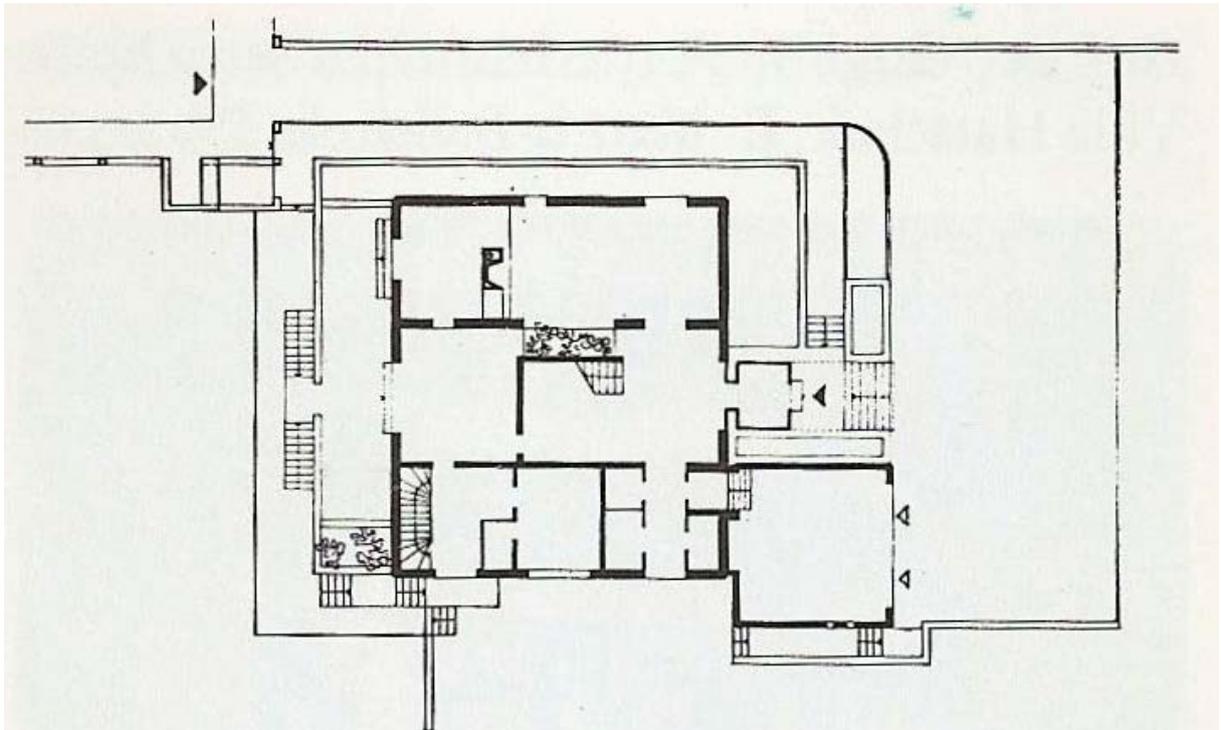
Grundriss Haus Wurm (Goffitzer)
